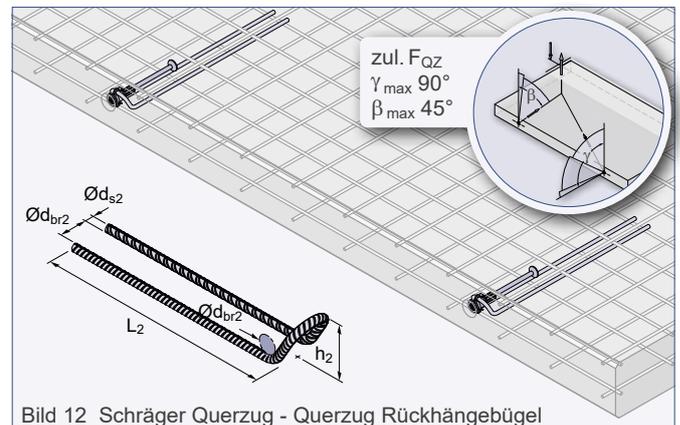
Schräger Querzug - Querzug Rückhängebügel
